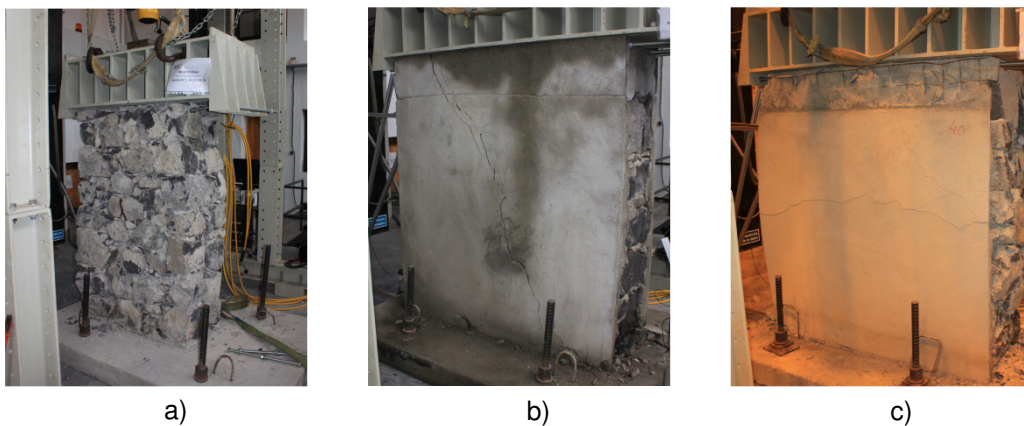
Aspeto dos painéis após conclusão de ensaio biaxial: a) ME.0-G1-V2; b) ME.3-G2-V2; e, 3) ME.4-G2-V2.
